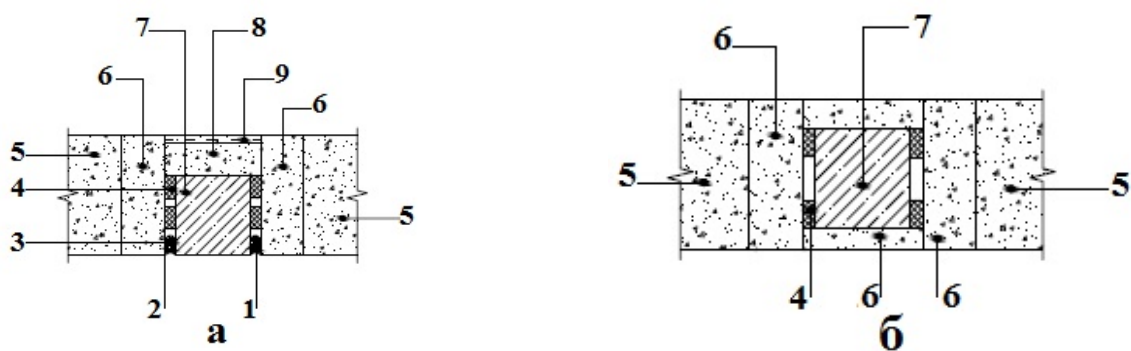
Схемы примыкания стен из газобетонных блоков к железобетонной колонне каркаса: а — снаружи; б — в середине; 1 — затирка цементно-песчаным раствором; 2 — герметизирующая нетвердеющая мастика; 3 — пороизол; 4 — минеральная вата; 5 — блоки YTONG; 6 — доборные блоки; 7 — железобетонная колонна каркаса; 8 — вкладыш из эффективного утеплителя; 9 — штукатурка по сетке
